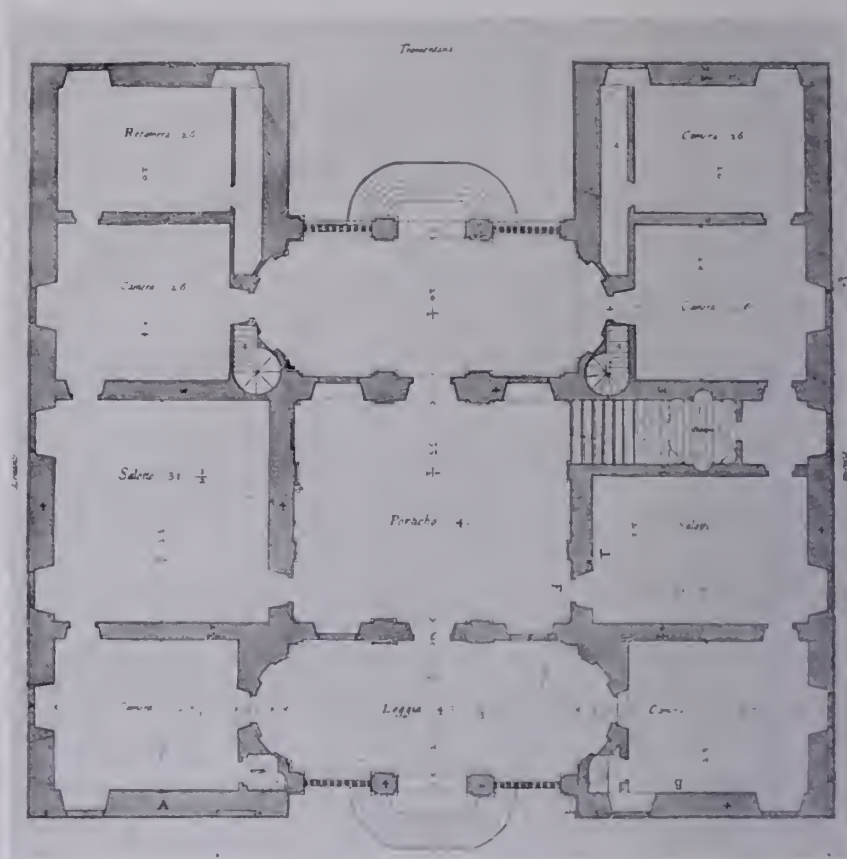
Genova, Villa delle Peschiere. Alessi: Pianta del pianterreno.
